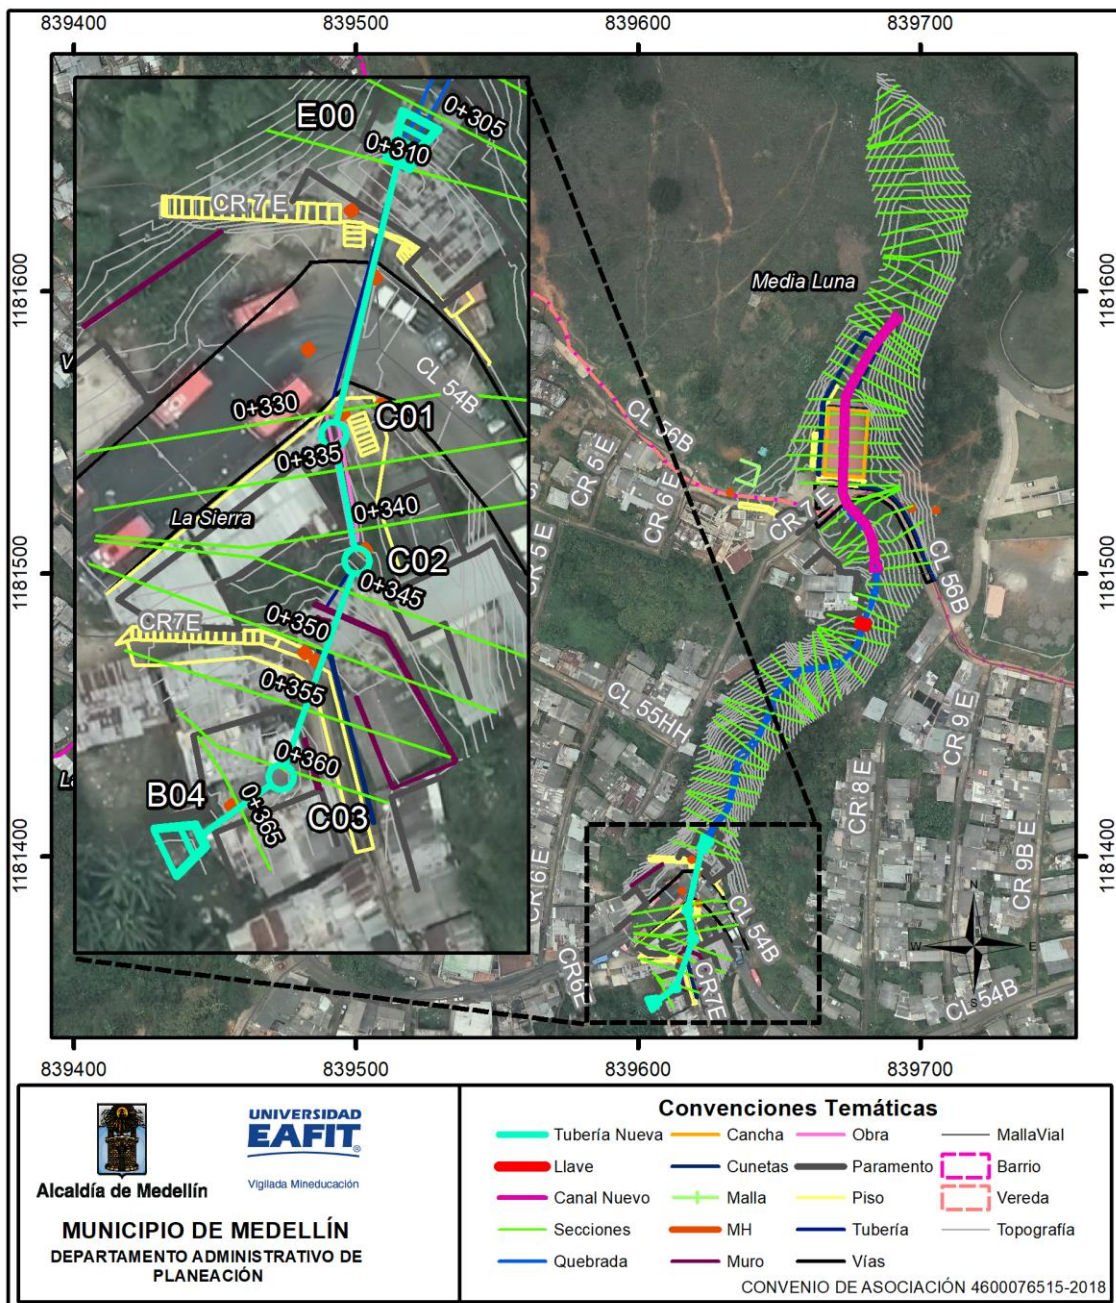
Localización en planta de las redes de alcantarillado planteadas.
